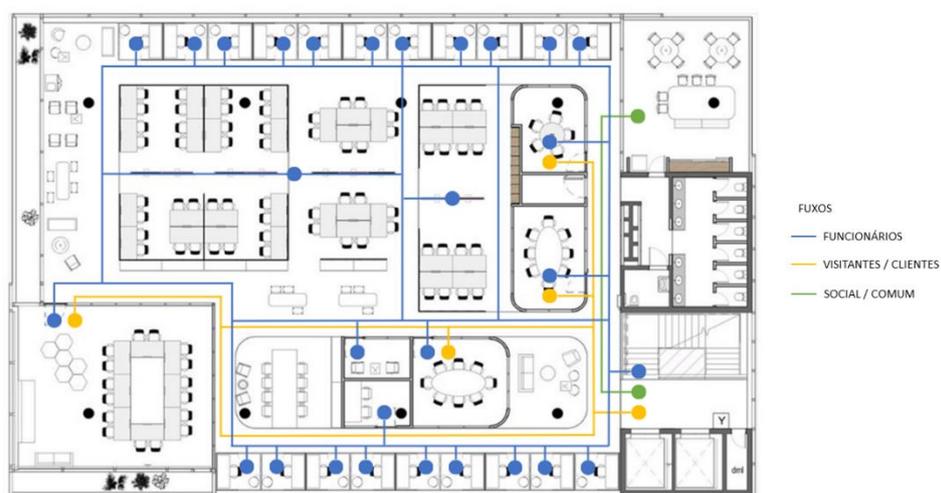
Fluxo – Escritórios Alice, Planta 1º Pavimento
